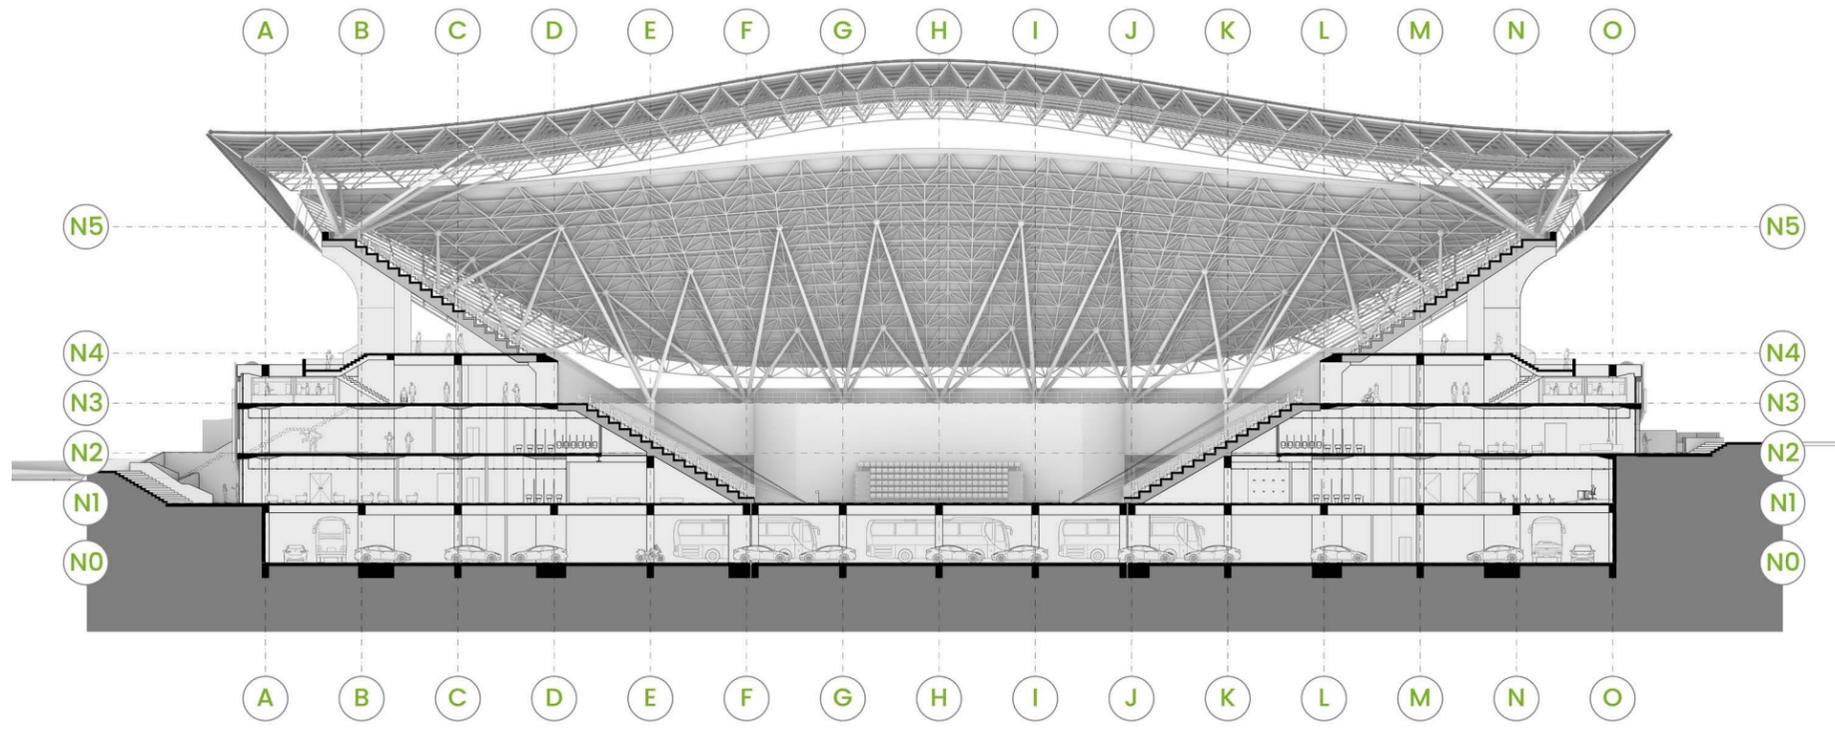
Corte en eje 5. Escala 1:600. Elaboración propia.
